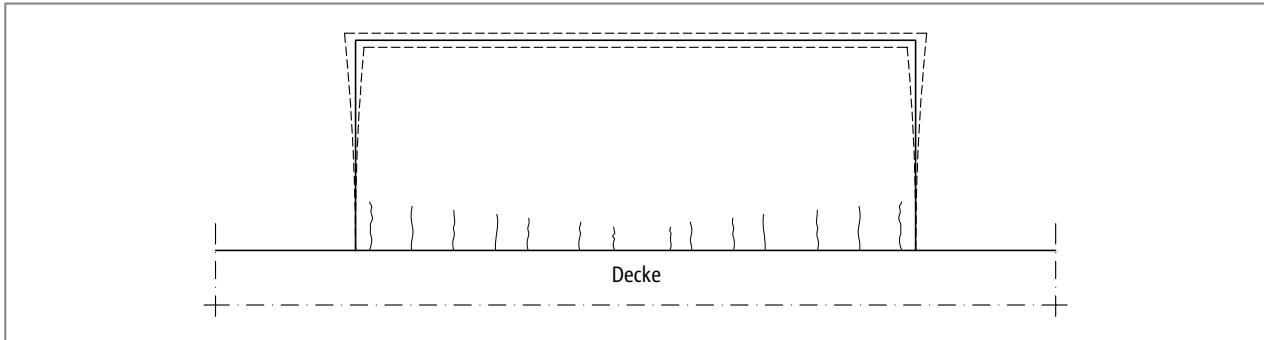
Balkonplatte ohne Schöck Isokorb®: Rissbildung durch Ermüdung möglich
